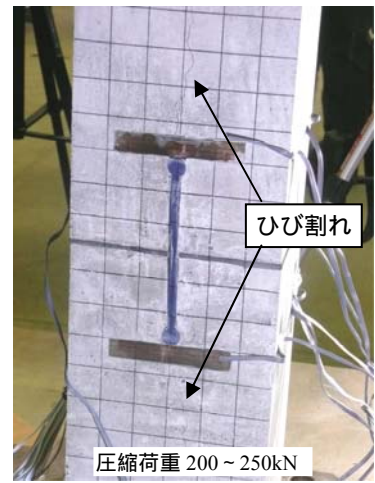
供試体 2 の載荷途中のひび割れ発生状況
